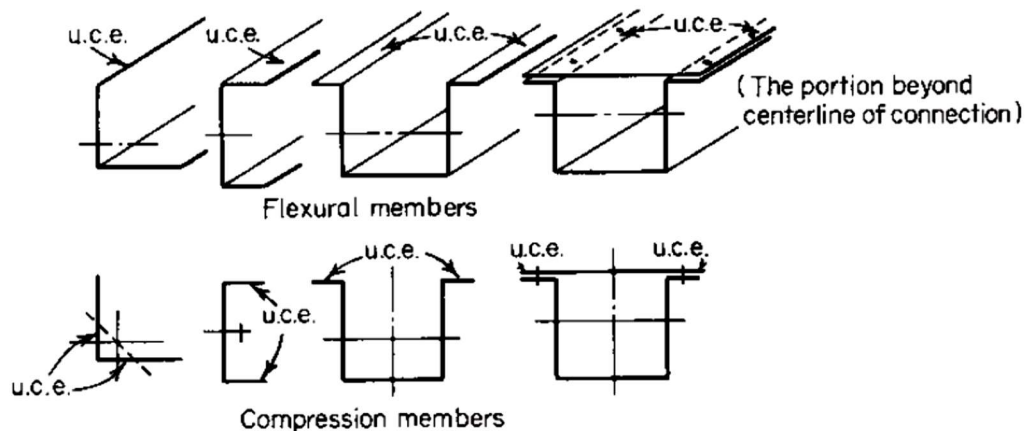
Elementos no atiesados en perfiles estructurales. [4]
